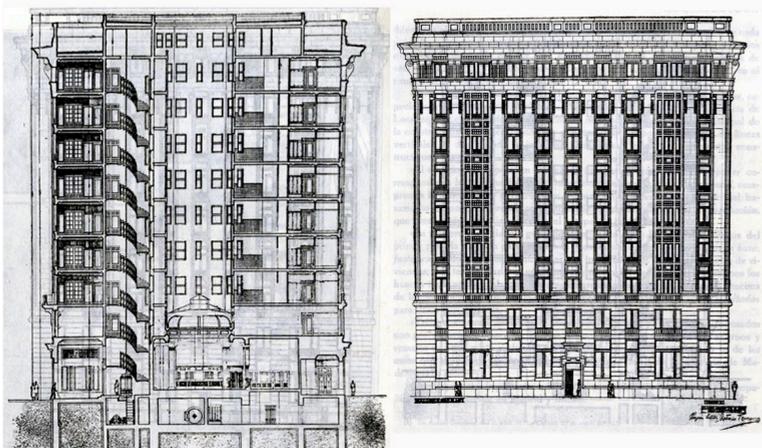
Sección y alzado de la fachada lateral del Banco Pastor, en La Coruña. Arquitectos Antonio Tenreiro Rodríguez y Peregrín Estellés Planells. 1922. *Revista de Arquitectura*, 37 (mayo de 1922), pp. 217-218
